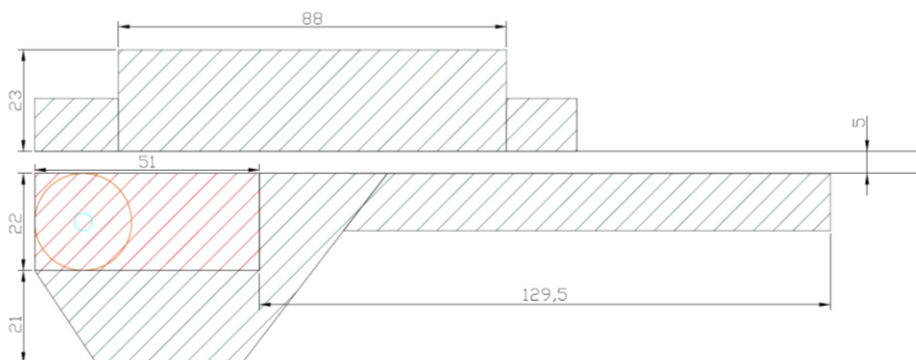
Tipico piazzola di cantiere con quote espresse in metri
